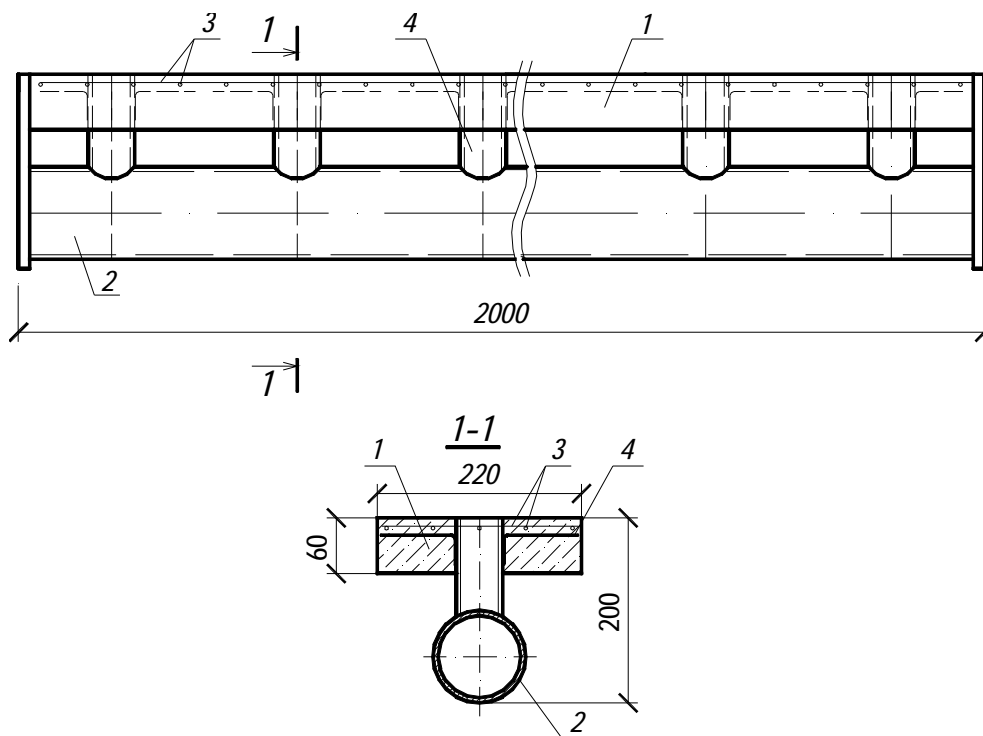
Сталезалізобетонна балка з армуванням трубою
